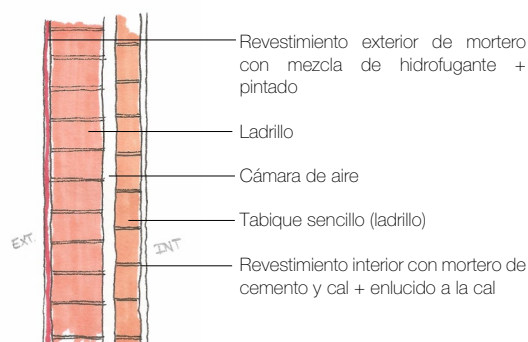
Detalle en sección de la pared de fachada (autoría propia).
